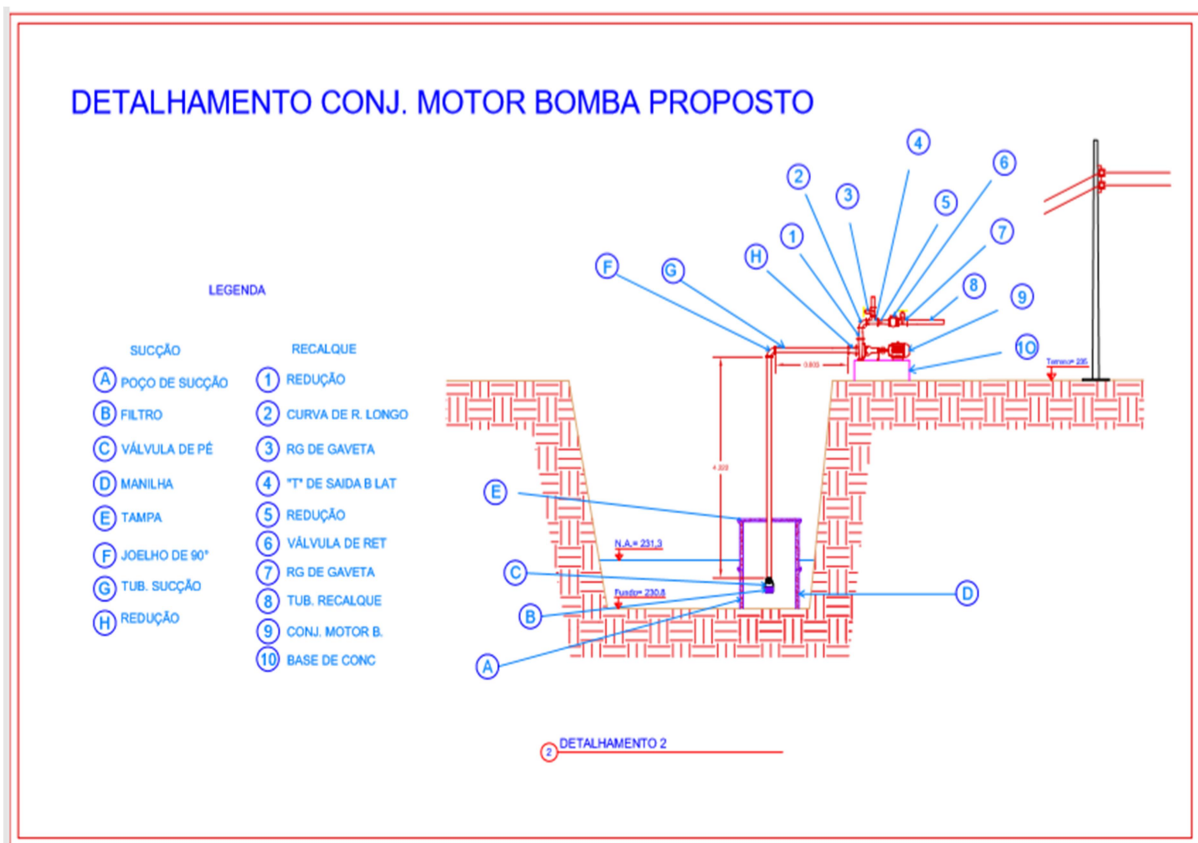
; detalhamento conj. motor bomba redimensionado (Fonte: Autocad)
